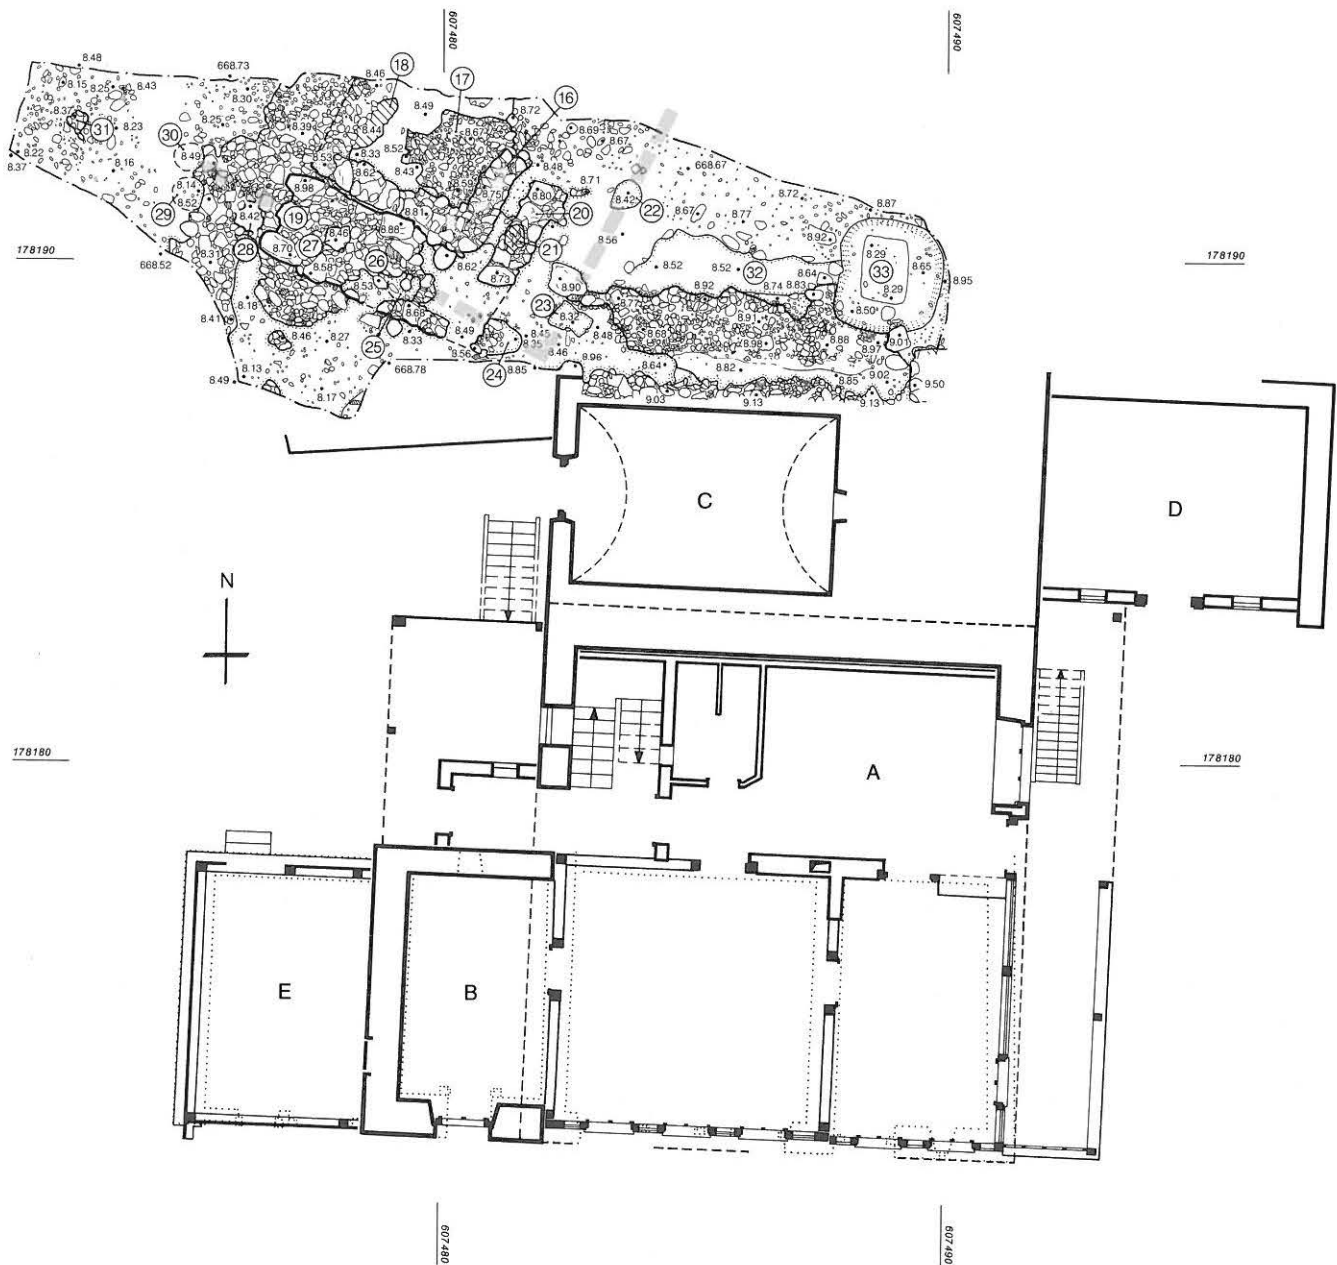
Längenbühl, Hattigen. Grabungsbefunde im Nordwesten des Hauses sowie Grundriss des Erdgeschosses 45B. M. 1:150. Legende siehe Beschreibung der Befunde.
